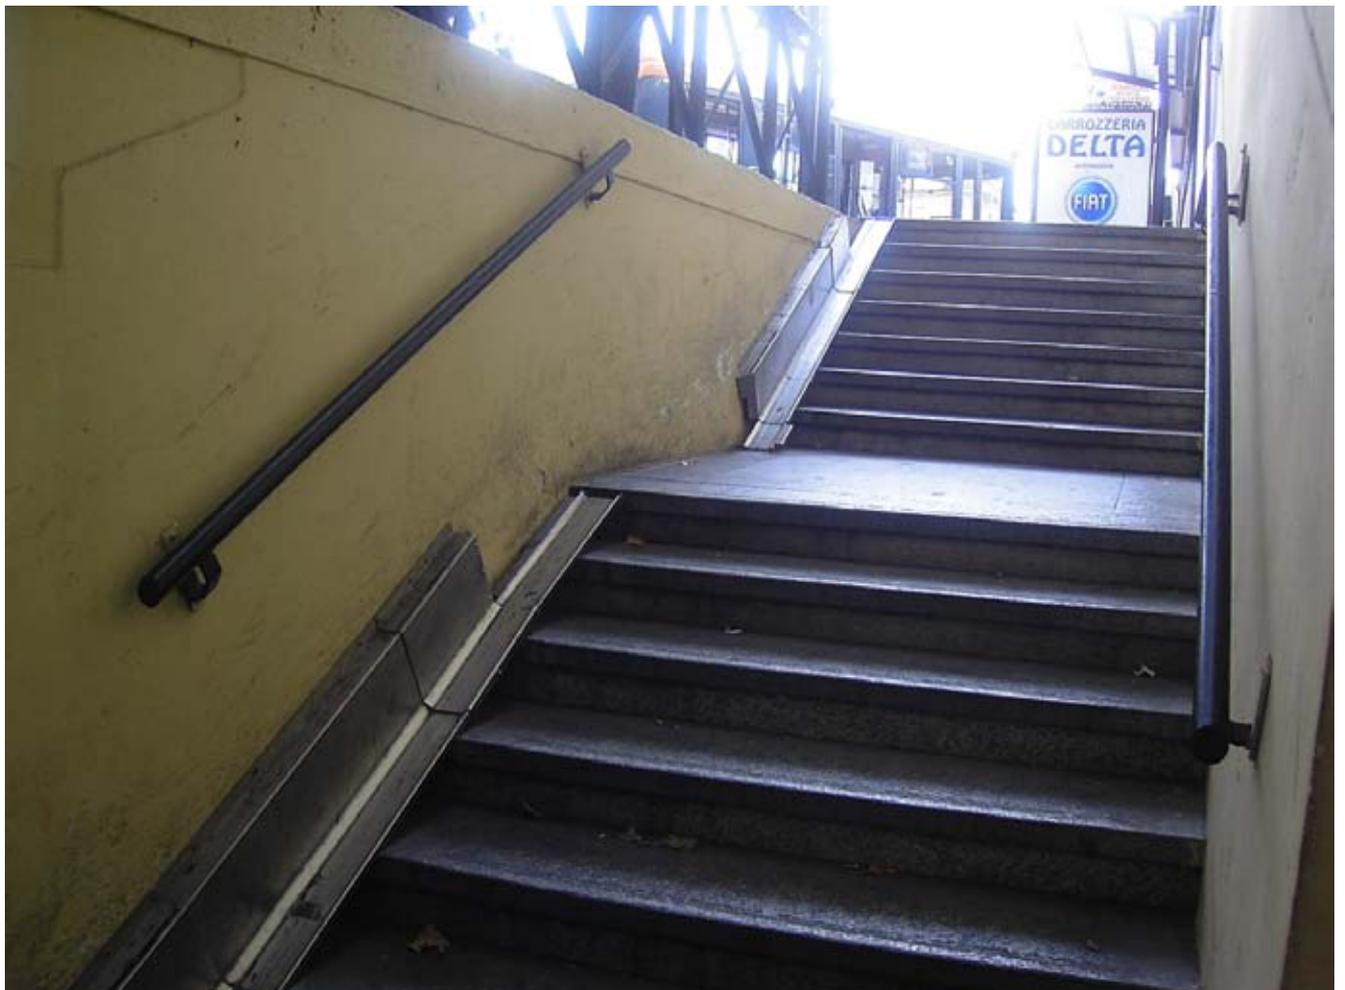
Rho: sottopassaggio con canalina prototipo.
